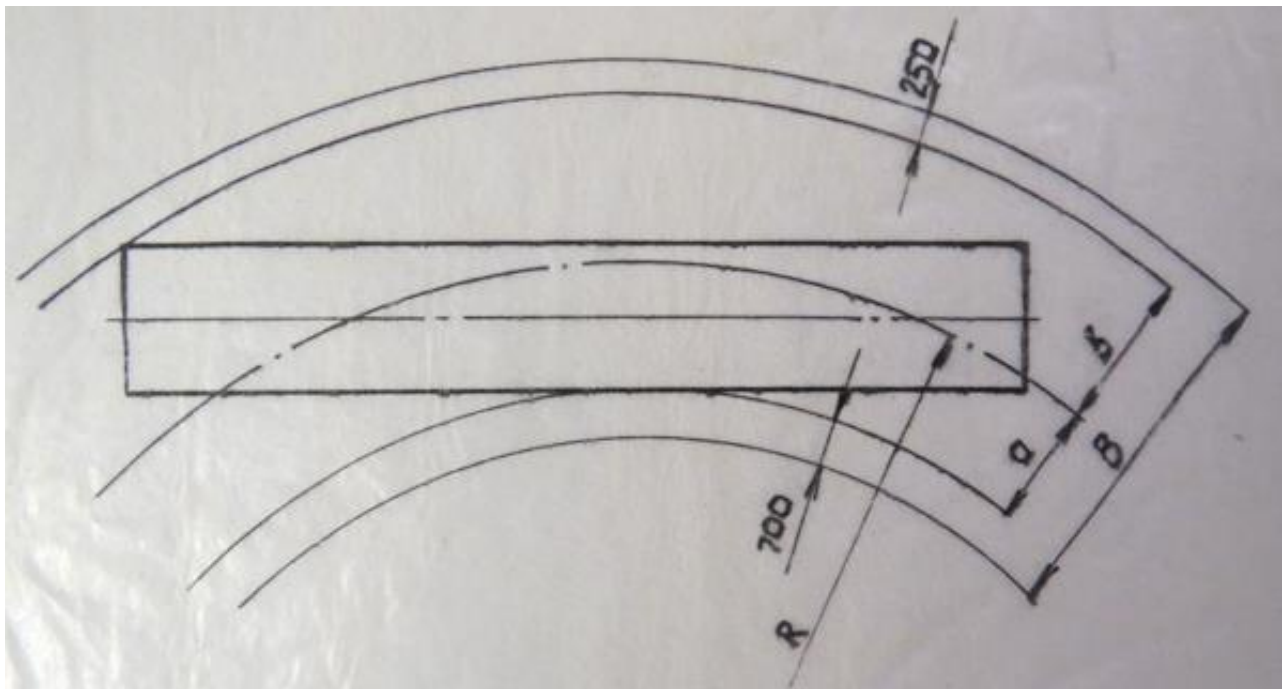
Схема до визначення ширини одноколійної виробки на заокругленнях рейкового шляху
